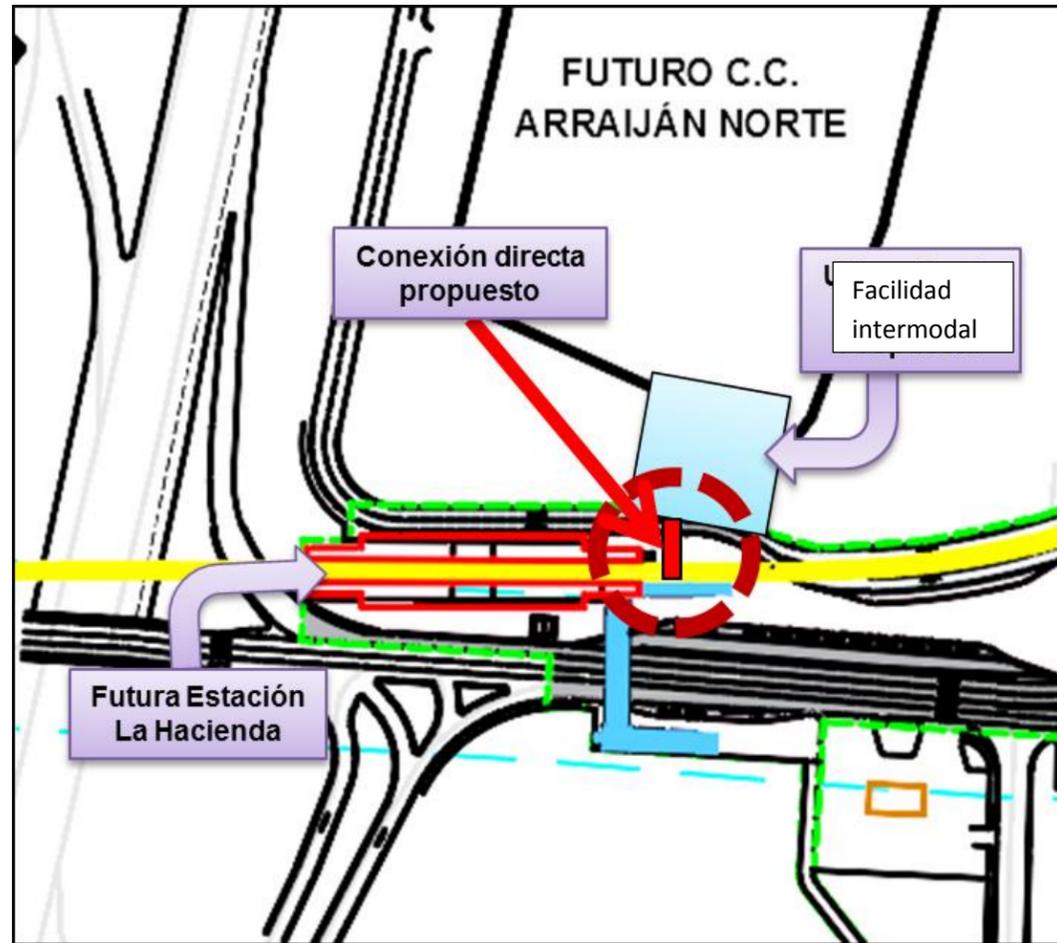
Imagen de ubicación de terminal propuesto en el futuro Centro Urbano Comercial Arraiján Norte.
